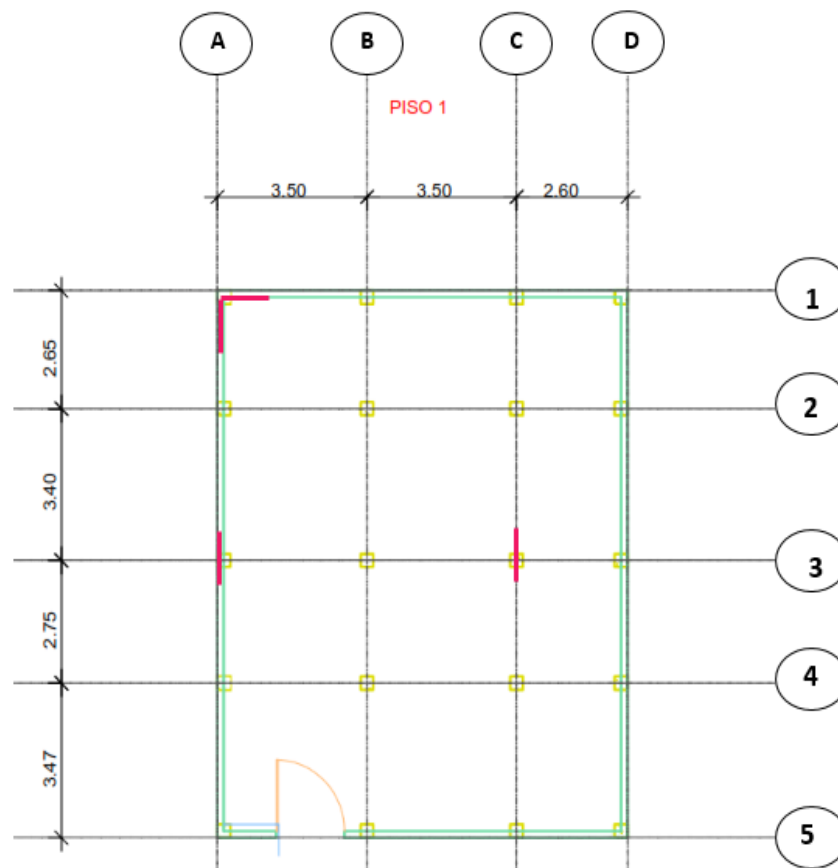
Planos de elementos a ensayar con el esclerómetro en el primer piso.
